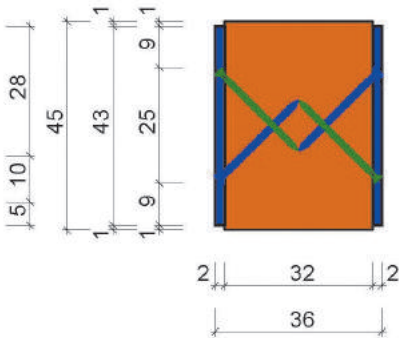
Geplanter Gurtstoß mit außen liegenden Blechen und durchgeschraubten Vollgewindeschrauben
